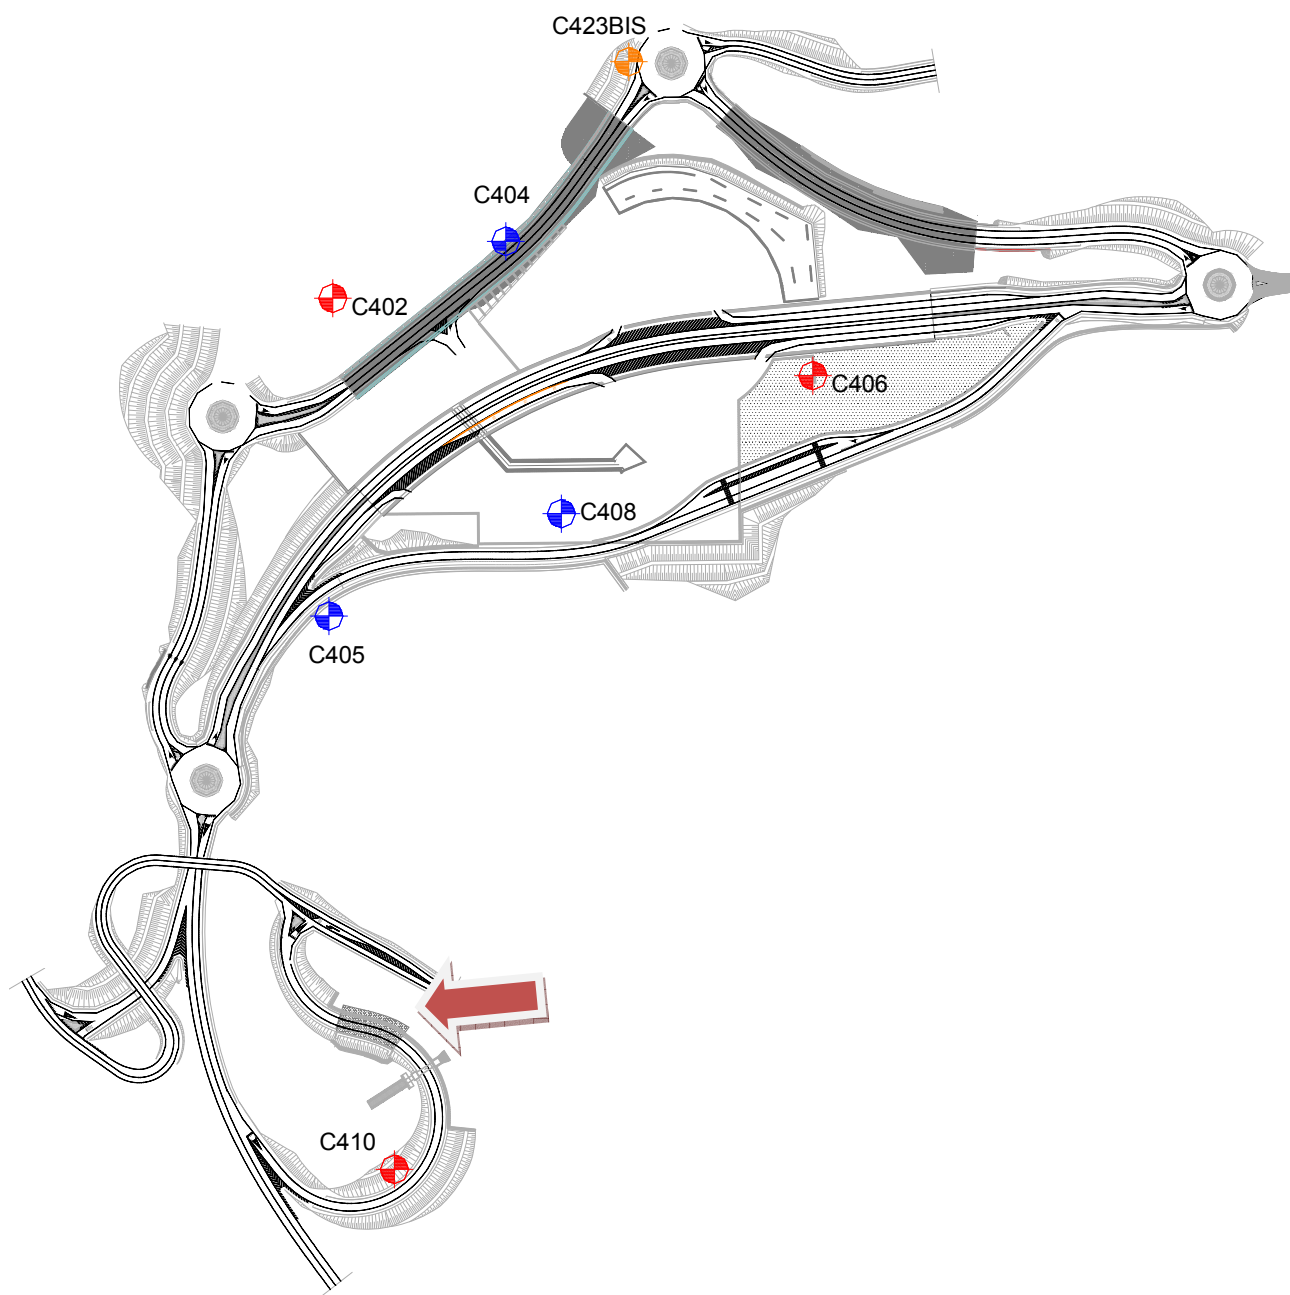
Stralcio planimetrico con ubicazione delle opere e dei sondaggi
